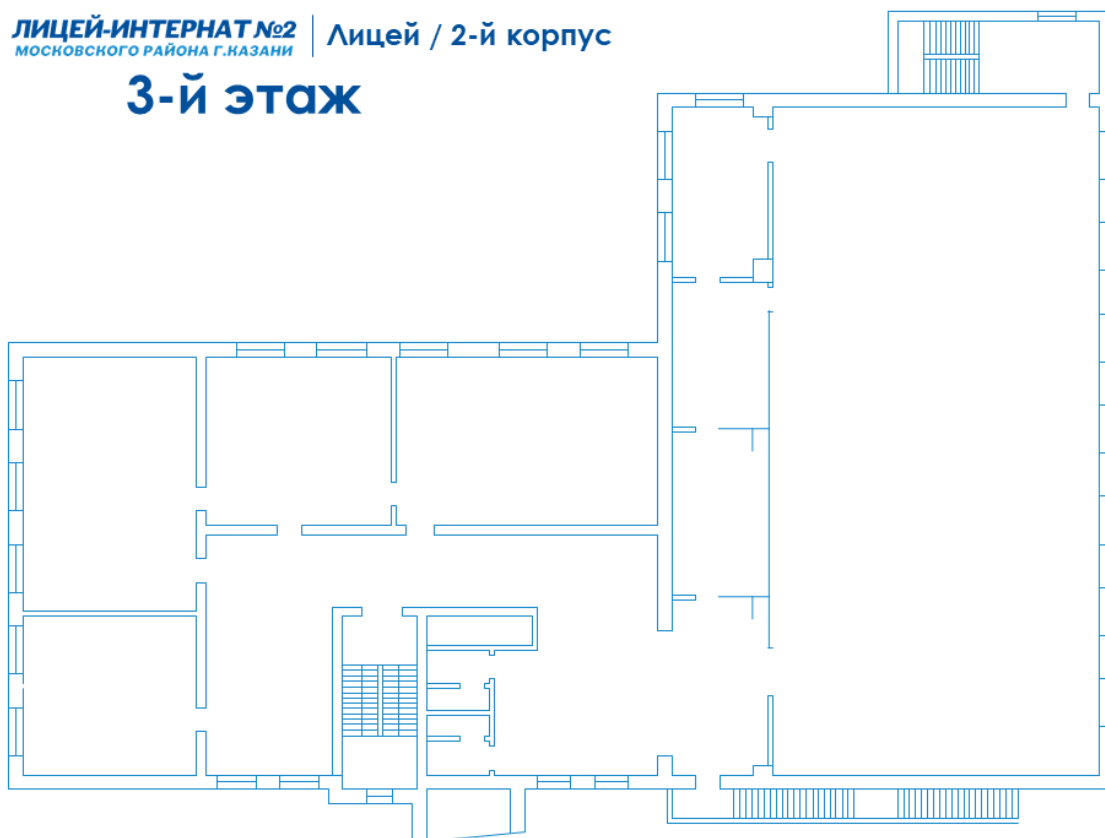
3 этаж, 2-го корпуса лицея
